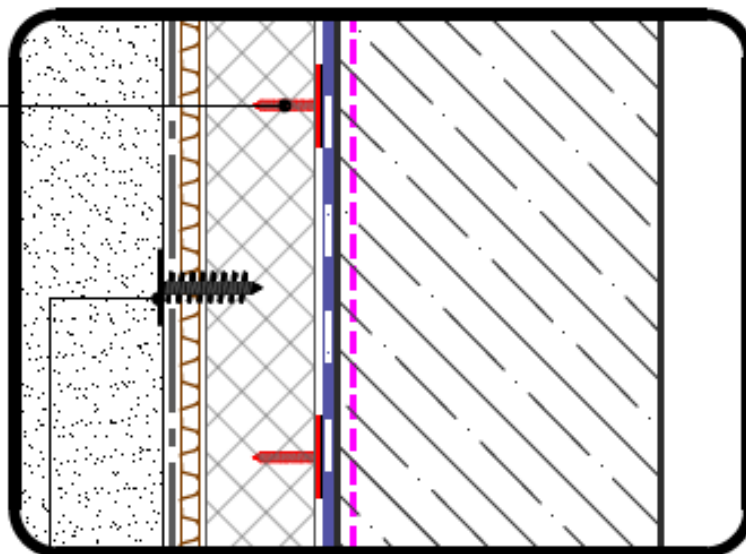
Гидроизоляция деформационного шва в стене
